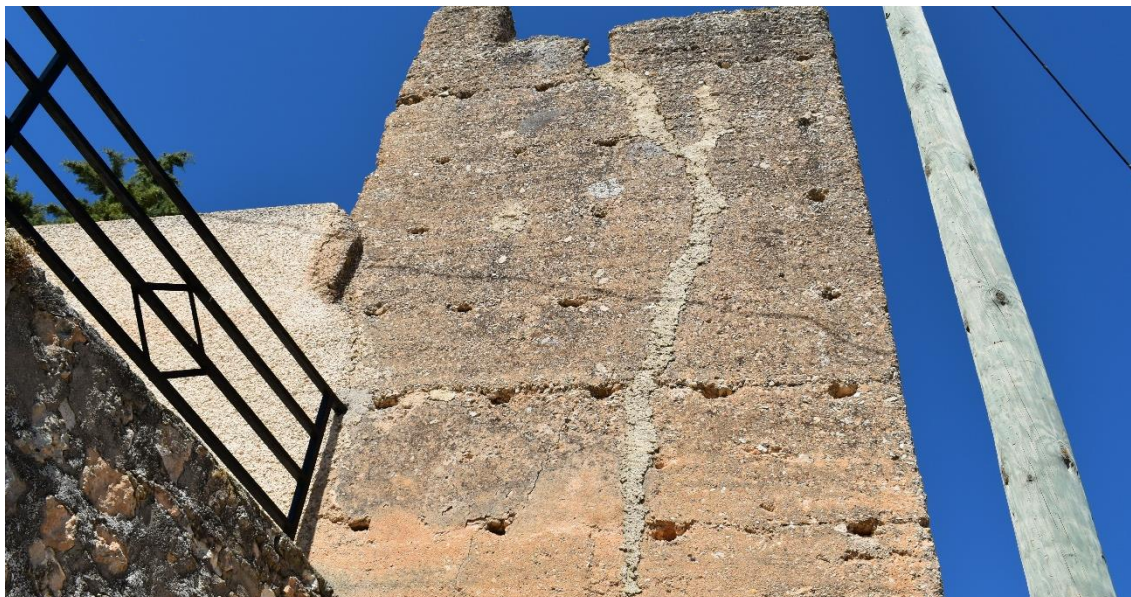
Detalle 1.1. Rellenado de grietas, cajeado y zunchado de torre A. Fuente: Autora.
